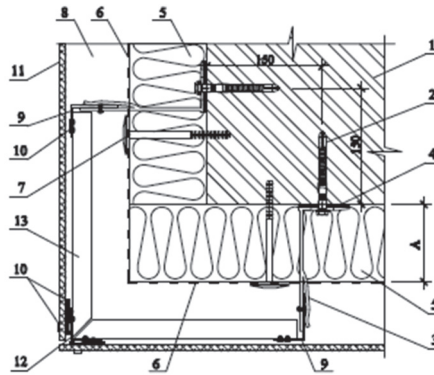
Конструктивна схема влаштування теплоізоляції по зовнішніх кутах будівлі
